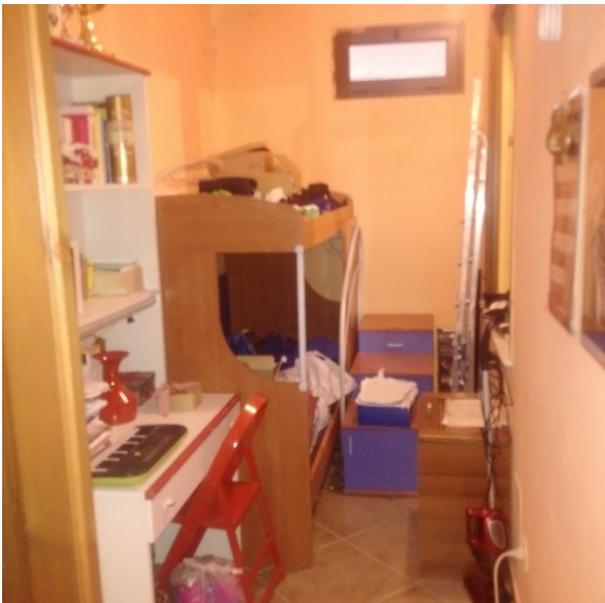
Stanza da letto singola con apertura a vasistas ricavata sull'indiana
